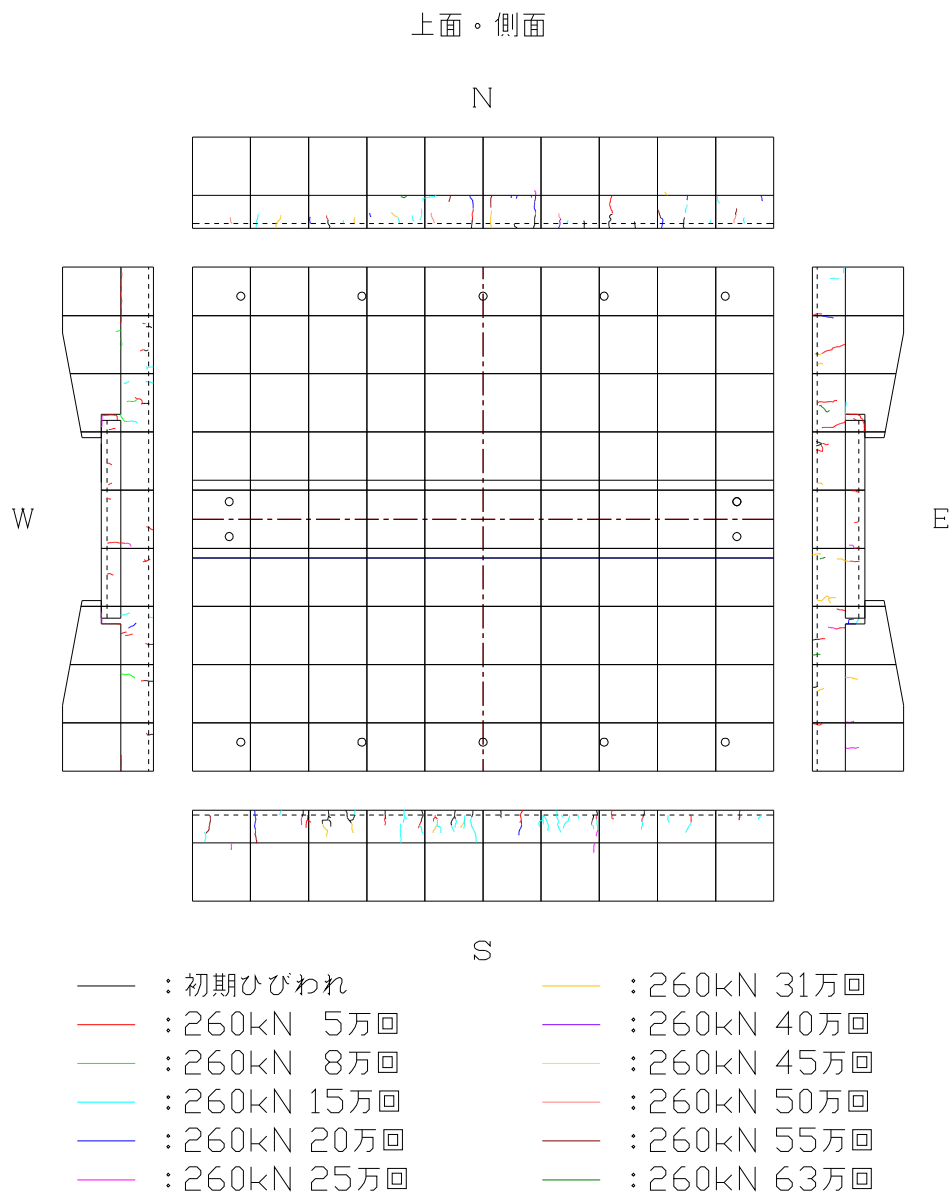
コンクリート上面および側面のひび割れ図
